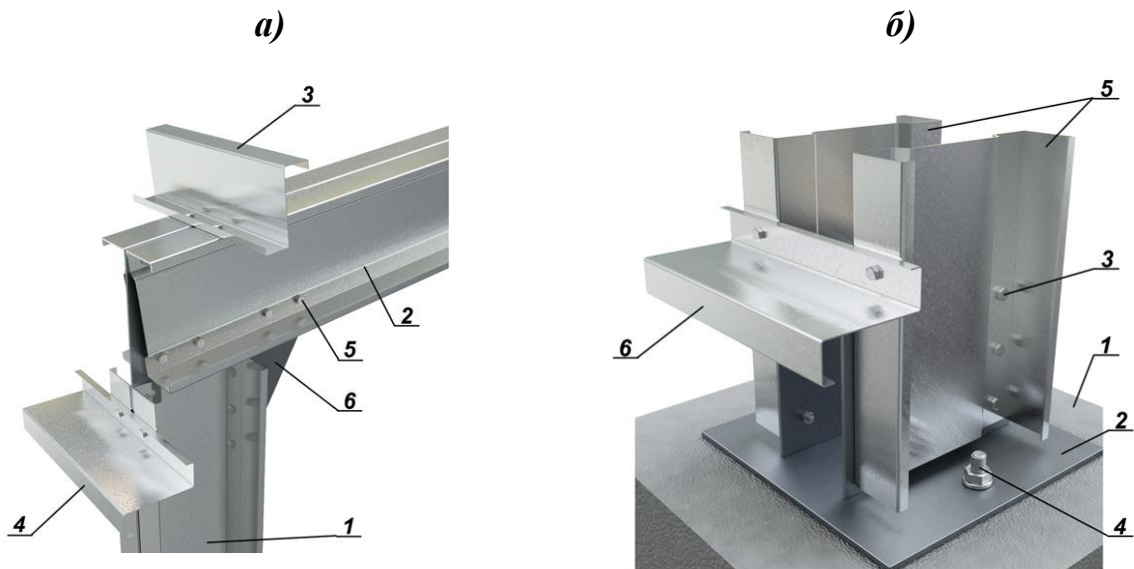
Вузли колони із ЛСТК [2]: а – карнизний вузол; б – опорний вузол
